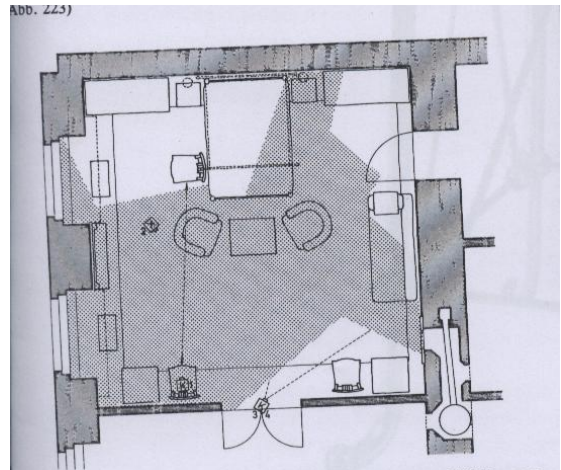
Wagner: Rekonstruierter Möbelgrundriss, Schlafzimmer, Köstlergasse, 1898
